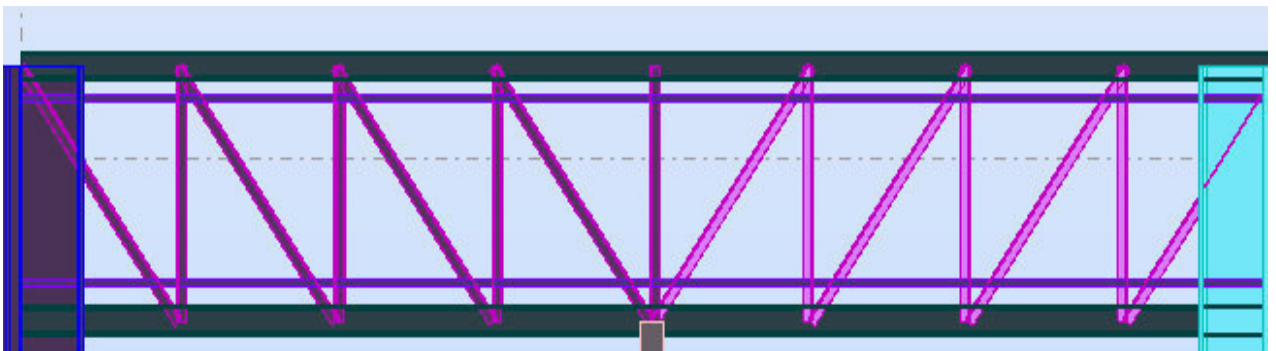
Poutre porteuse (poutre sablier) en treilles
